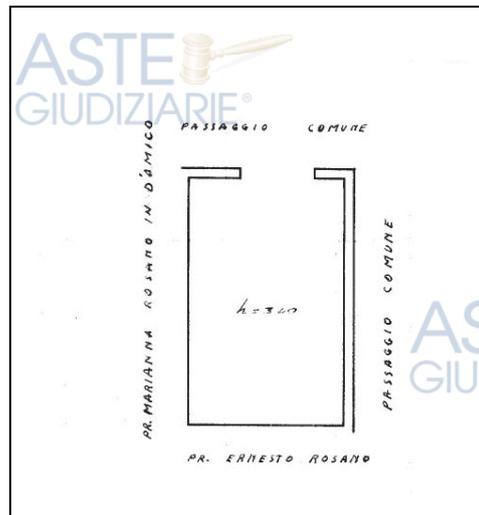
Estratto planimetria catastale del 03/06/1957. Magazzino sub. 4
